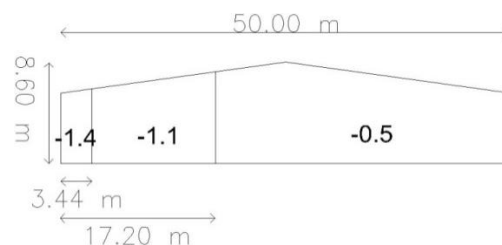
Disposição dos coeficientes de pressão exterior para as fachadas Poente e Nascente.
